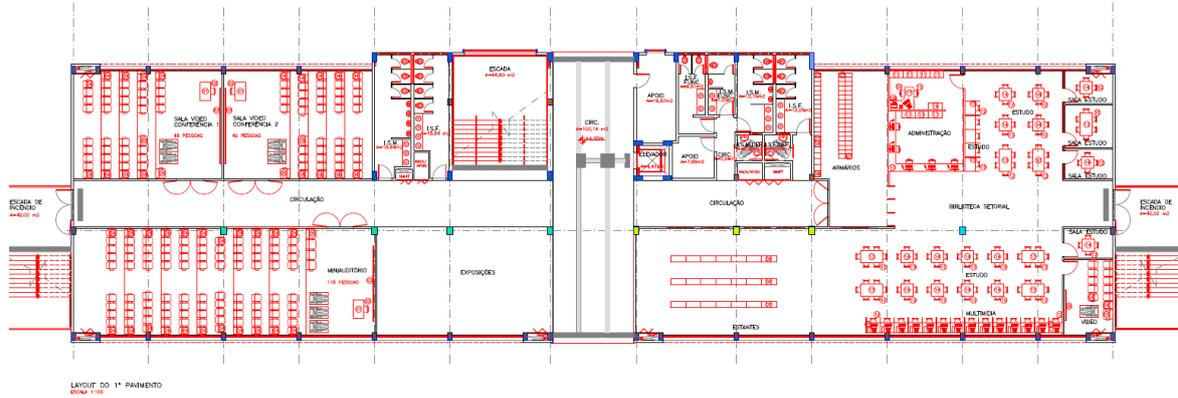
Planta baixa do 2º pavimento do Bloco C
